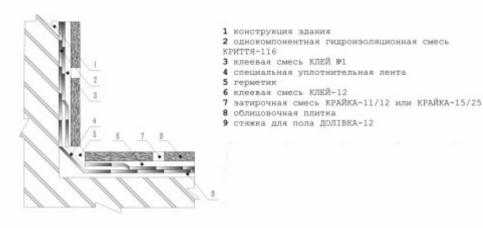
Вариант решения устройства гидроизоляции примыкания стена-пол.
